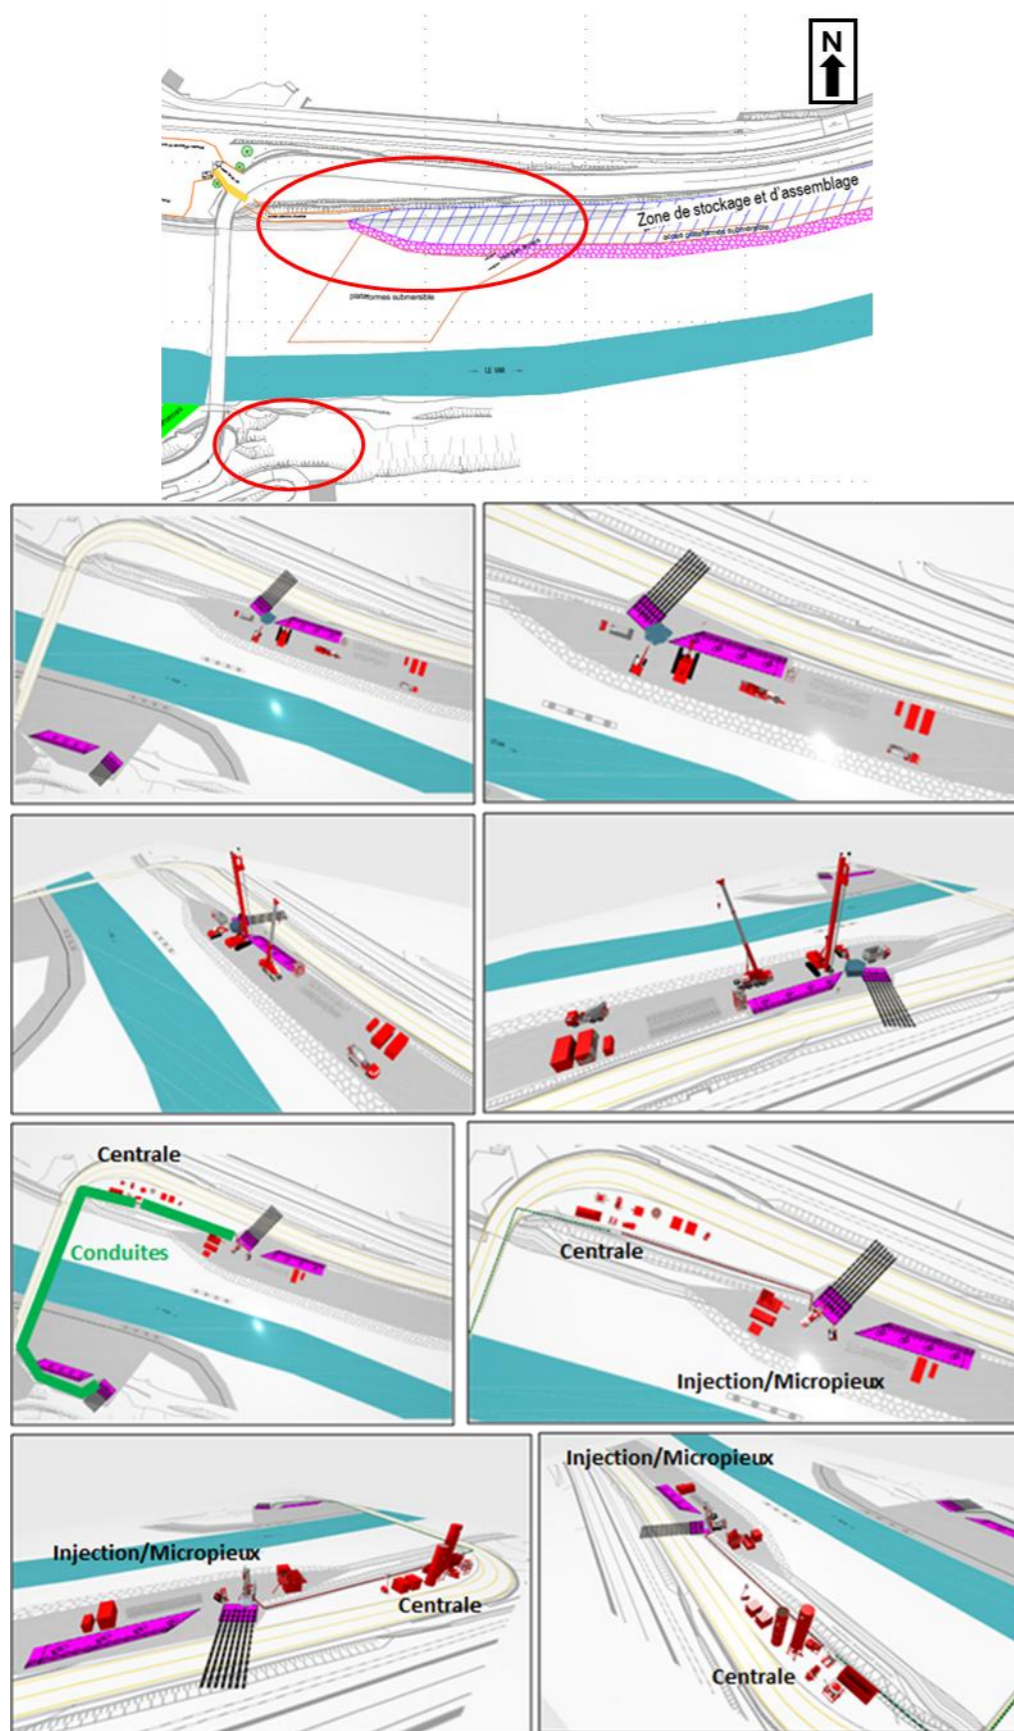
Plan d'installation de l'atelier de pieux rive gauche et en rive droite
